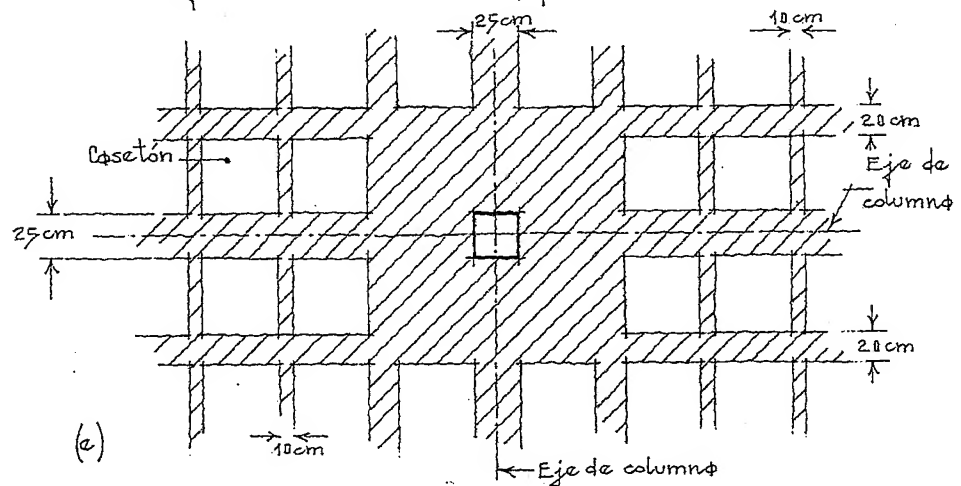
Macizo de concreto alrededor del capitel, (c). Planta.
